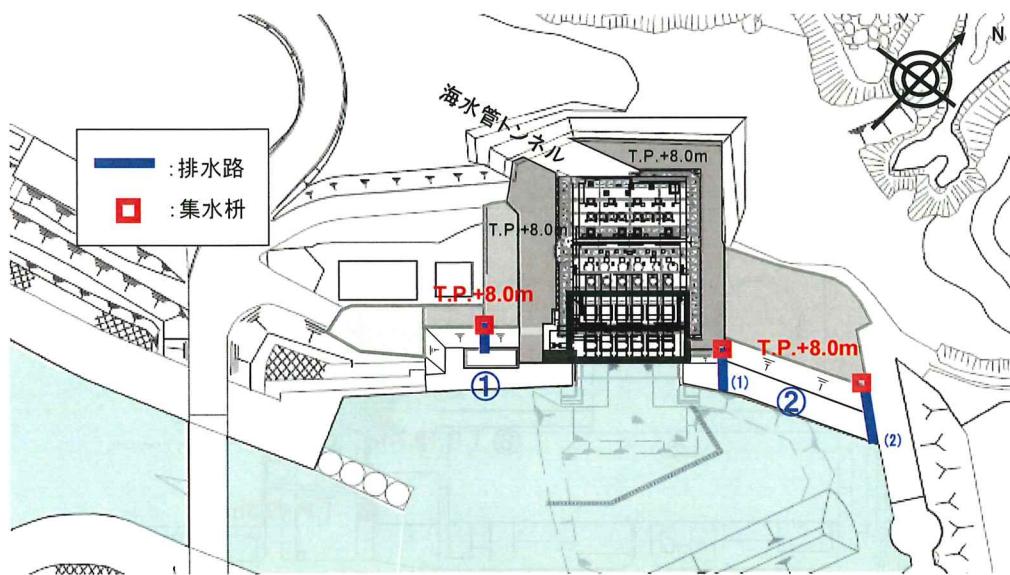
屋外排水路配置図（海水ポンプ室周辺）
